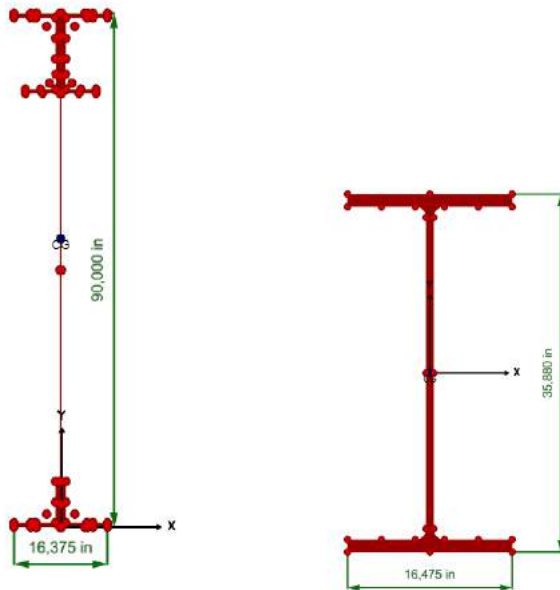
Coupes sectionnelles des poutres de 57' (gauche) et 23' de long (droite)
